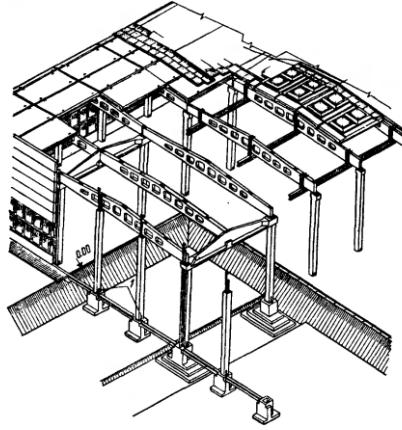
Монтаж перемичок заземлення при використанні стропильних та підстропильних балок для з'єднання металевої арматури будівлі
